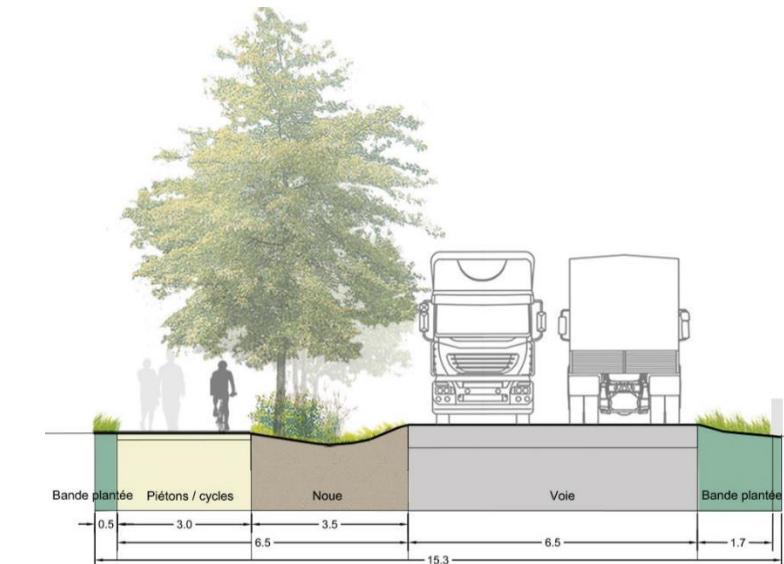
Profil de la voie secondaire (AVP, 2023)
